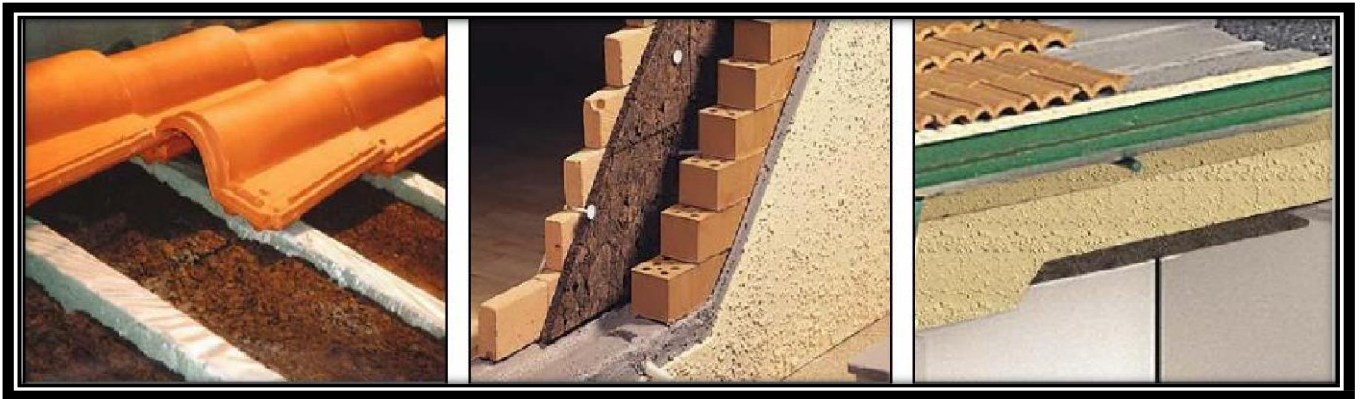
Isolation de la toiture, isolation des murs creux et des toitures et des combles isolés [79].
